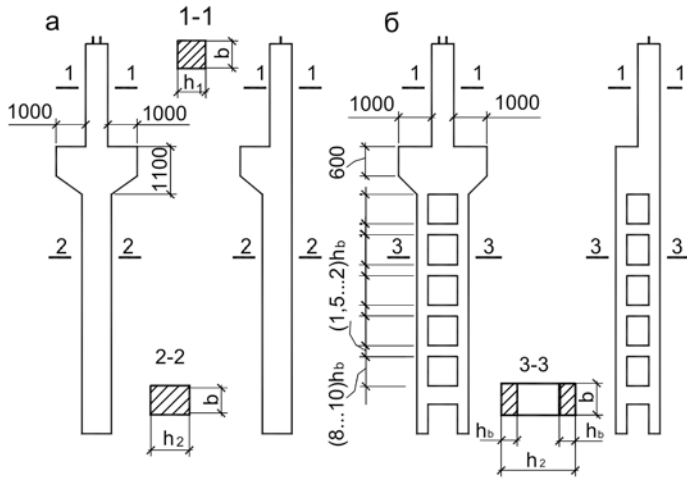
Типы колонн одноэтажных промышленных зданий
